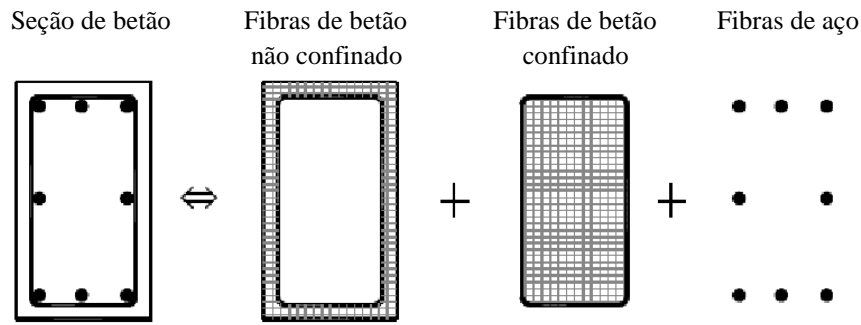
Discretização de uma seção de betão armado em fibras [41]
